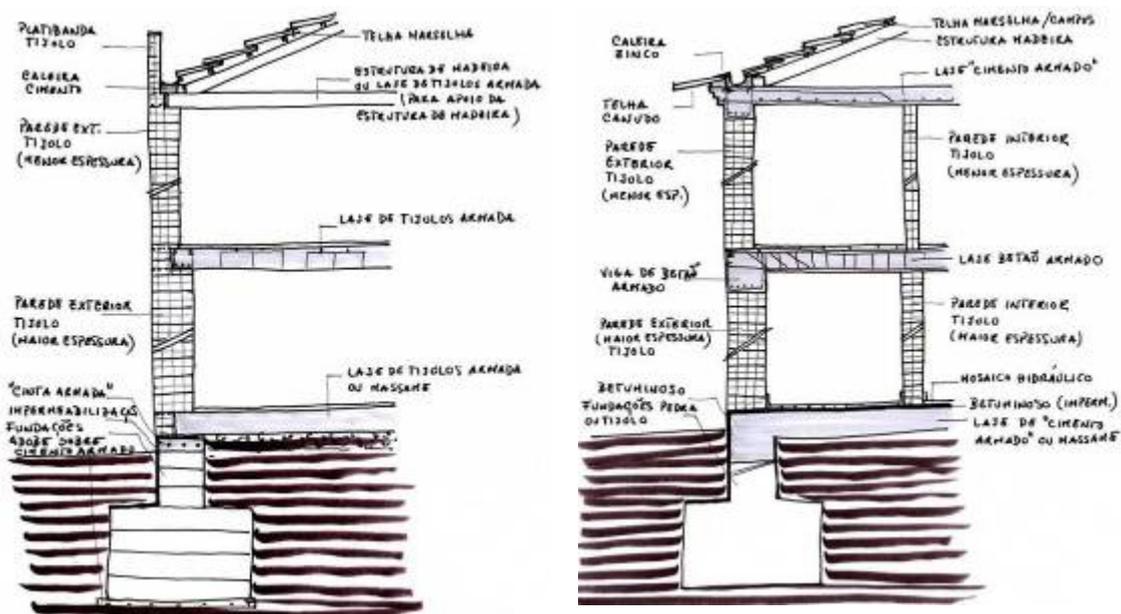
Esquema do sistema construtivo F Figura 20. Esquema do sistema construtivo G
